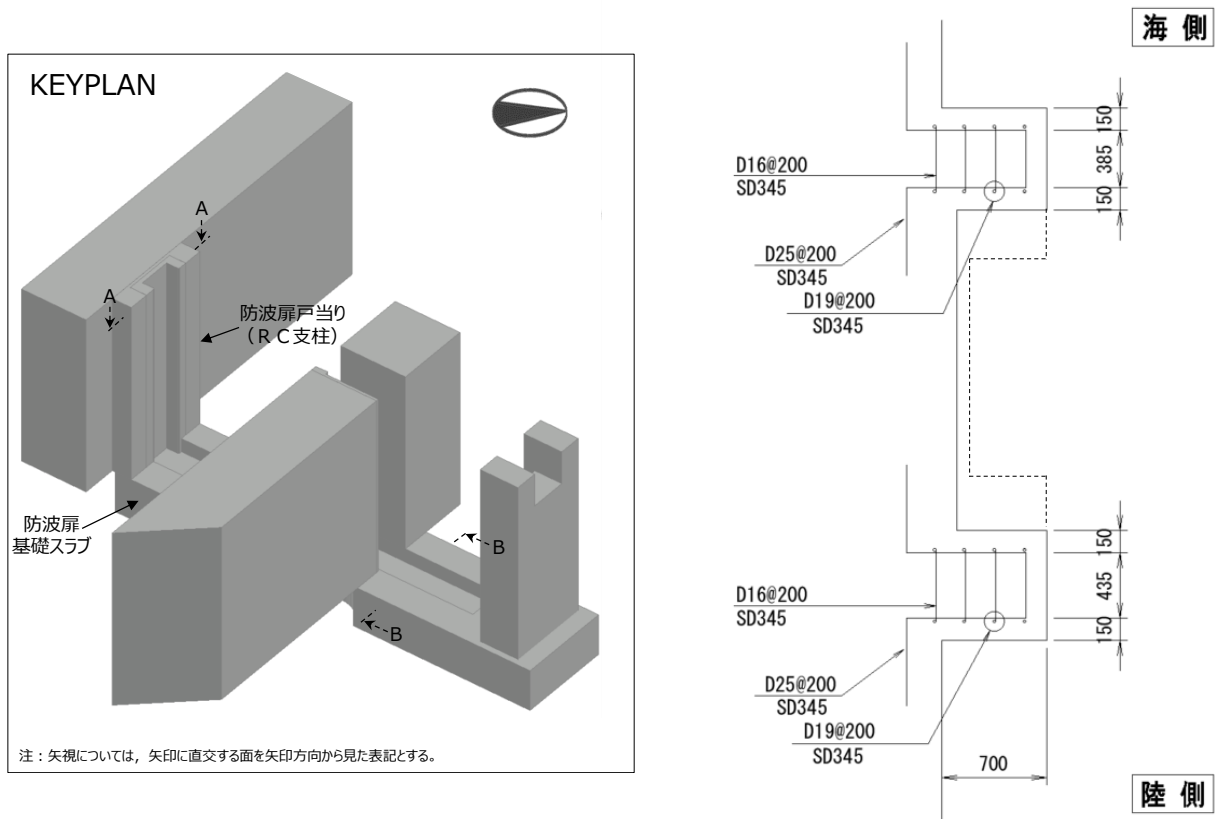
(1) 防波扉戸当り (RC支柱) の概略配筋図 (A-A 断面)
